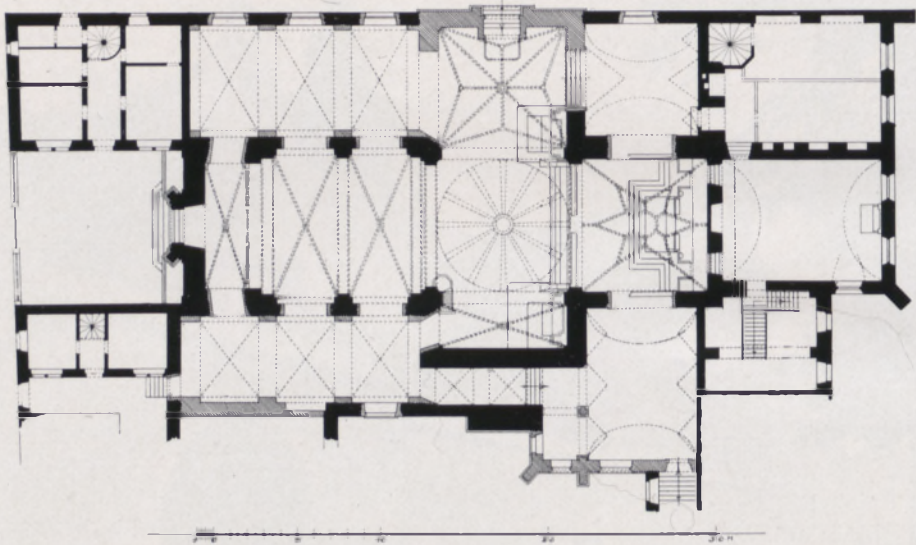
St. Maria in der Schnurgasse. Grundriss
